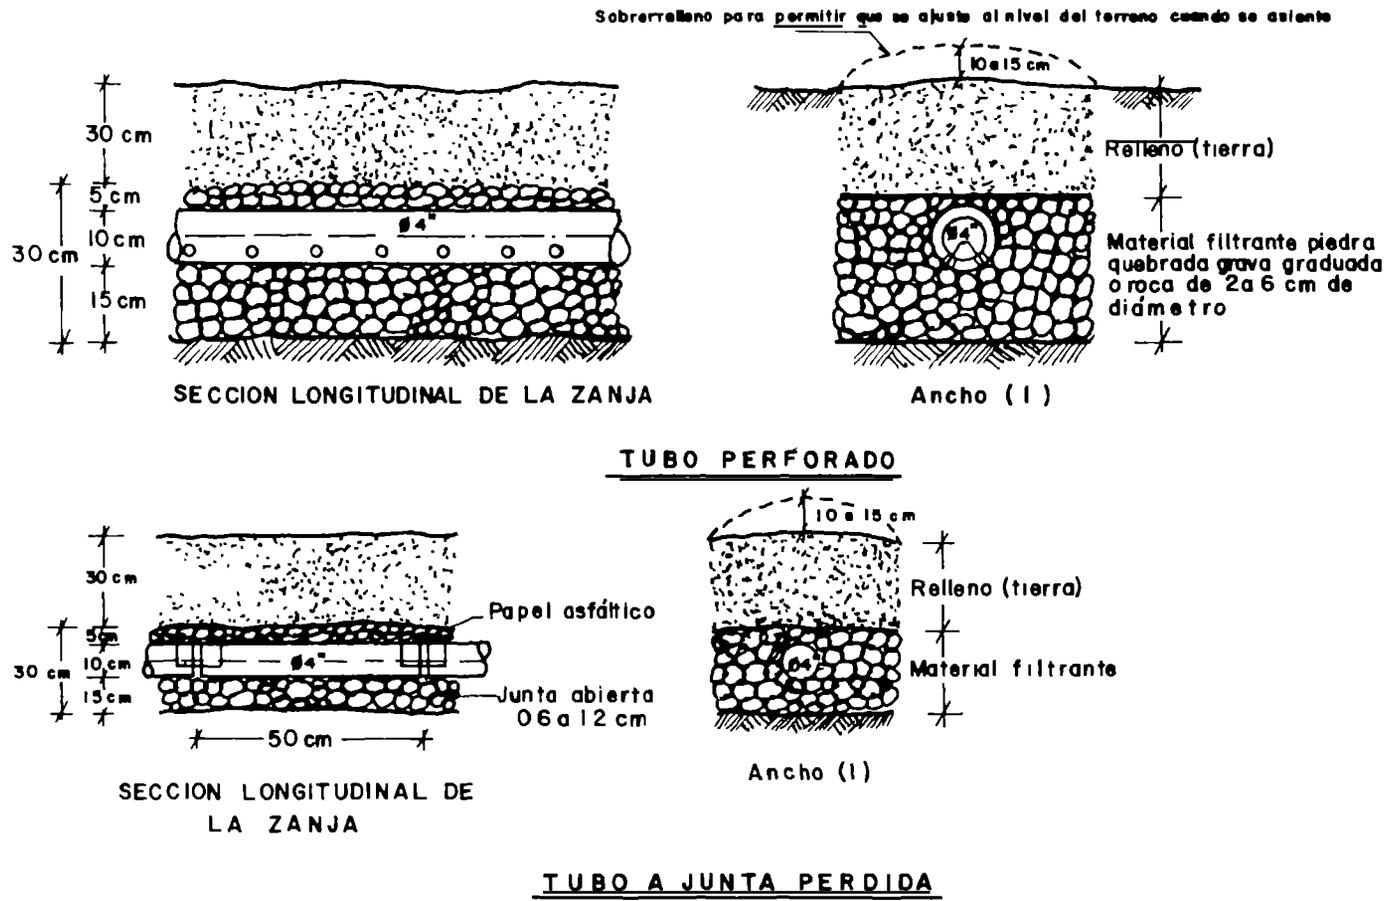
Esquema de medio filtrante para campos y zanjas de infiltración.
